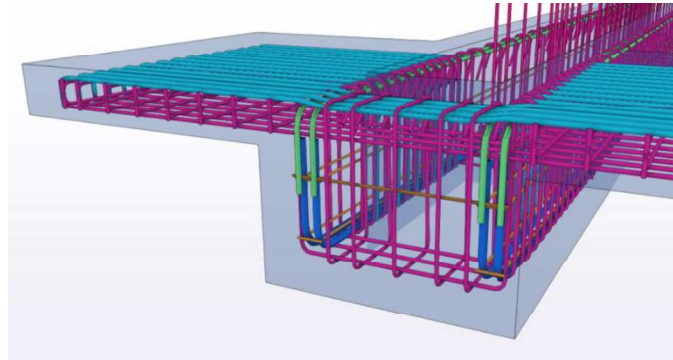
Prefabricado tipo viga T con barras grifadas(cyan). Elaboración propia
